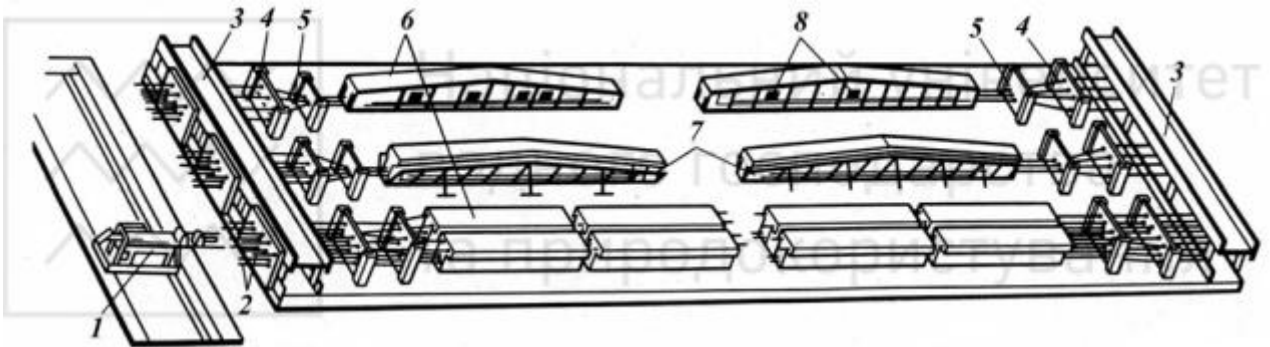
Довгий стенд для виготовлення попередньо напружених конструкцій: 1- гідродомкрат; 2- тяги з захватами; 3- упор стенда; 4- направляюча; 5- фіксуючі діафрагми; 6- виріб; 7- форми; 8- вібратори
